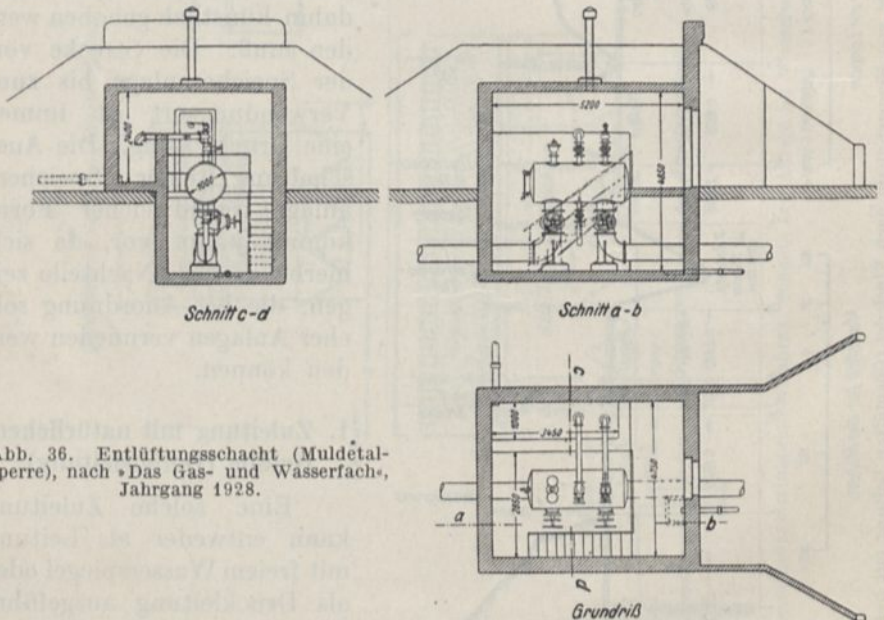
Entlüftungsschacht (Muldétal-sperre), nach »Das Gas- und Wasserfach«, Jahrgang 1928.
